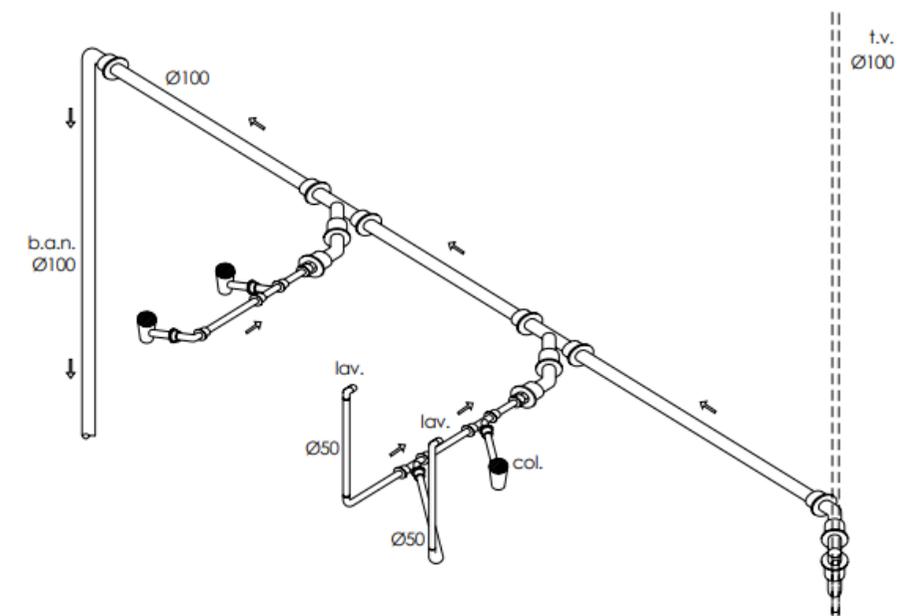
Conexión entre muebles de baño, tubo de ventilación y bajada de aguas negras
